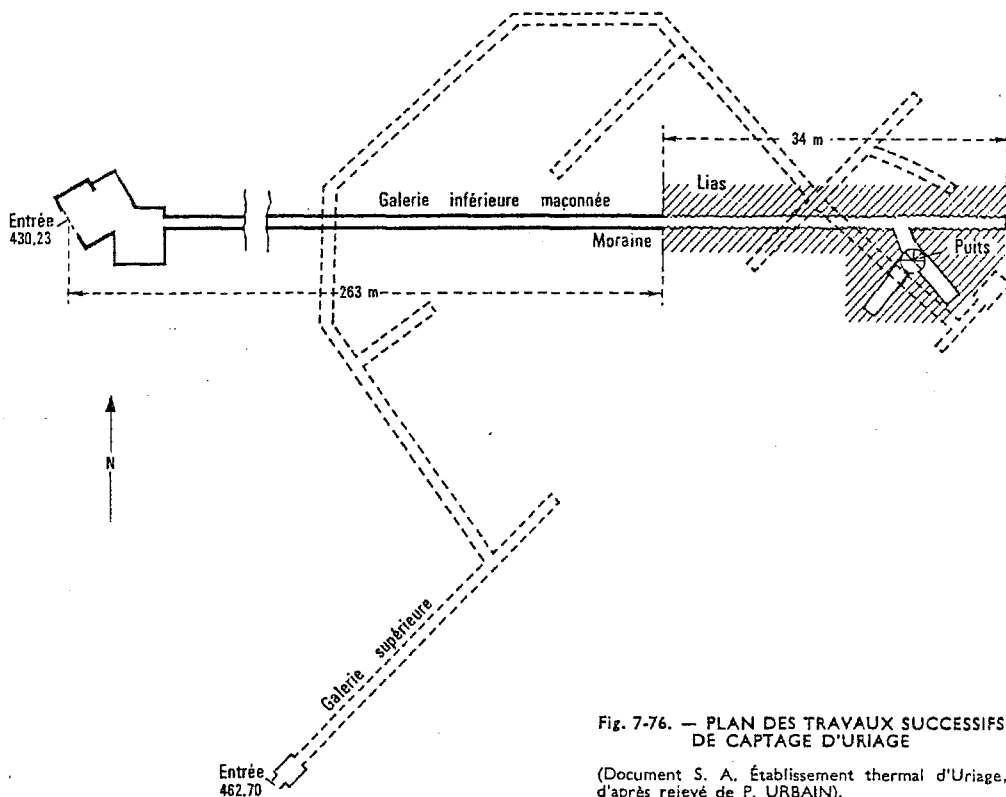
PLAN DES TRAVAUX SUCCESSIFS DE CAPTAGE D'URIAGE
